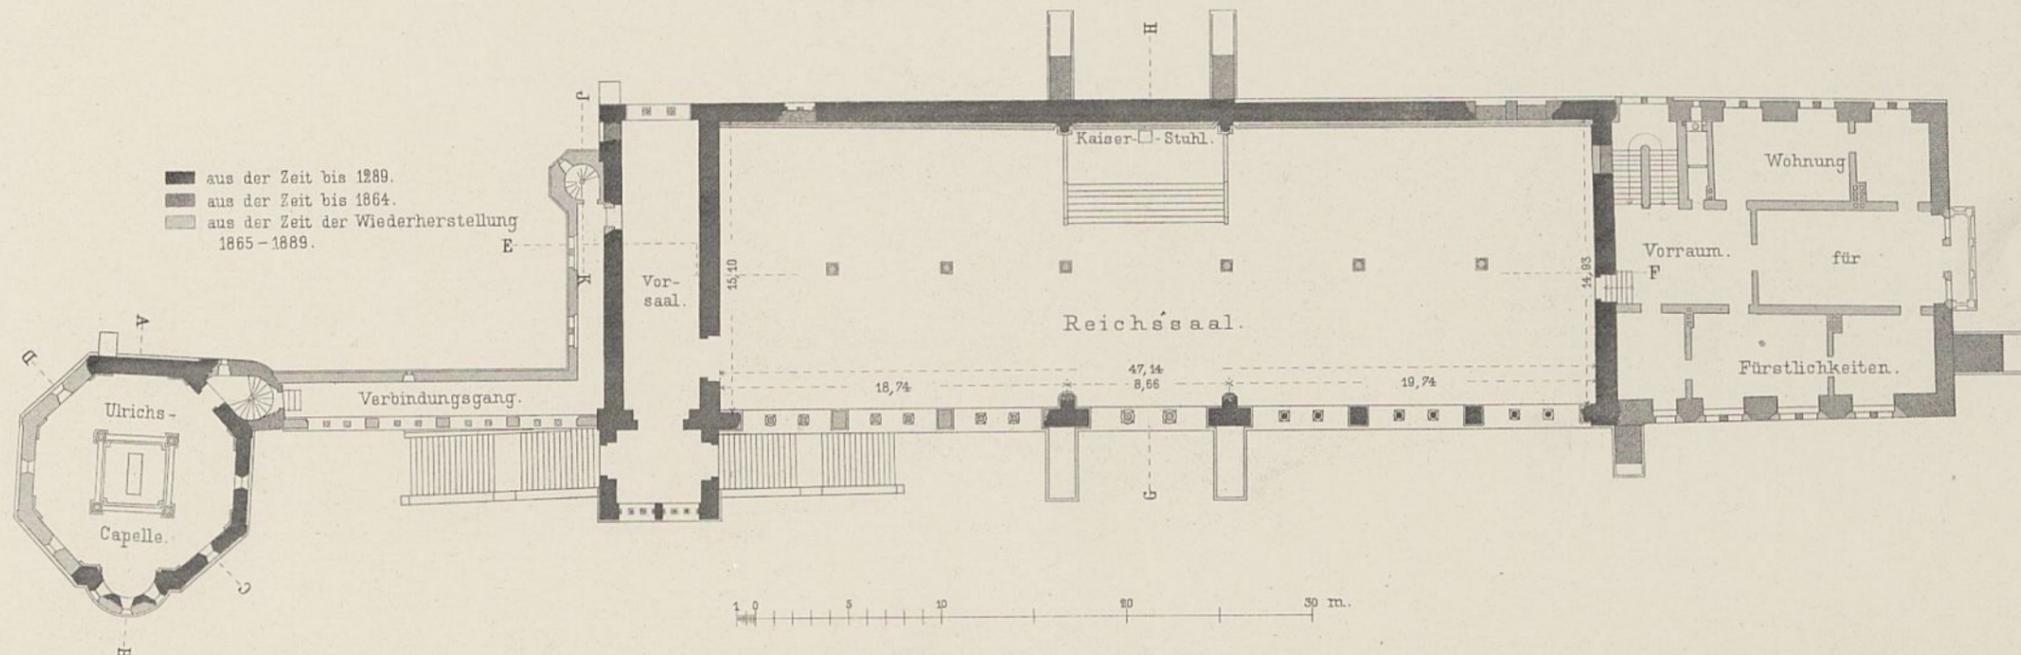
Grundriss des Hauptgeschosses.
